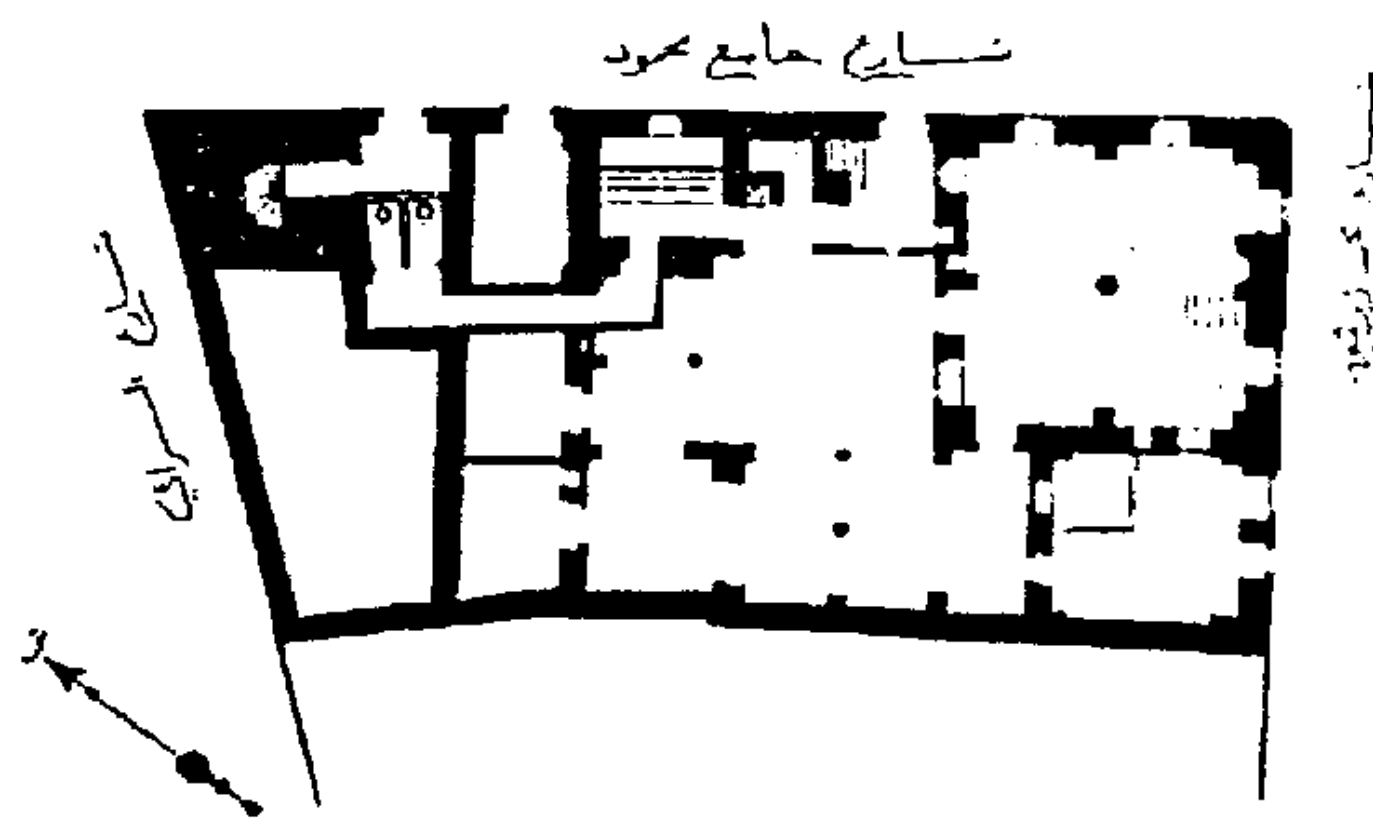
مسقط أفقي لجامع الشيخ عبد الوهاب عن الموسوعة (الجزء الأول).
